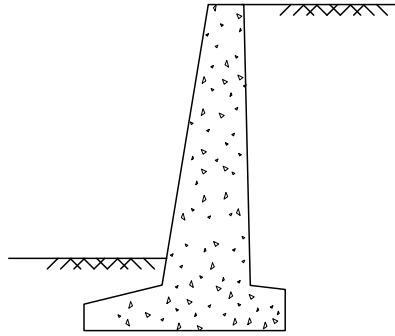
กำแพงกันดินแบบ gravity wall
